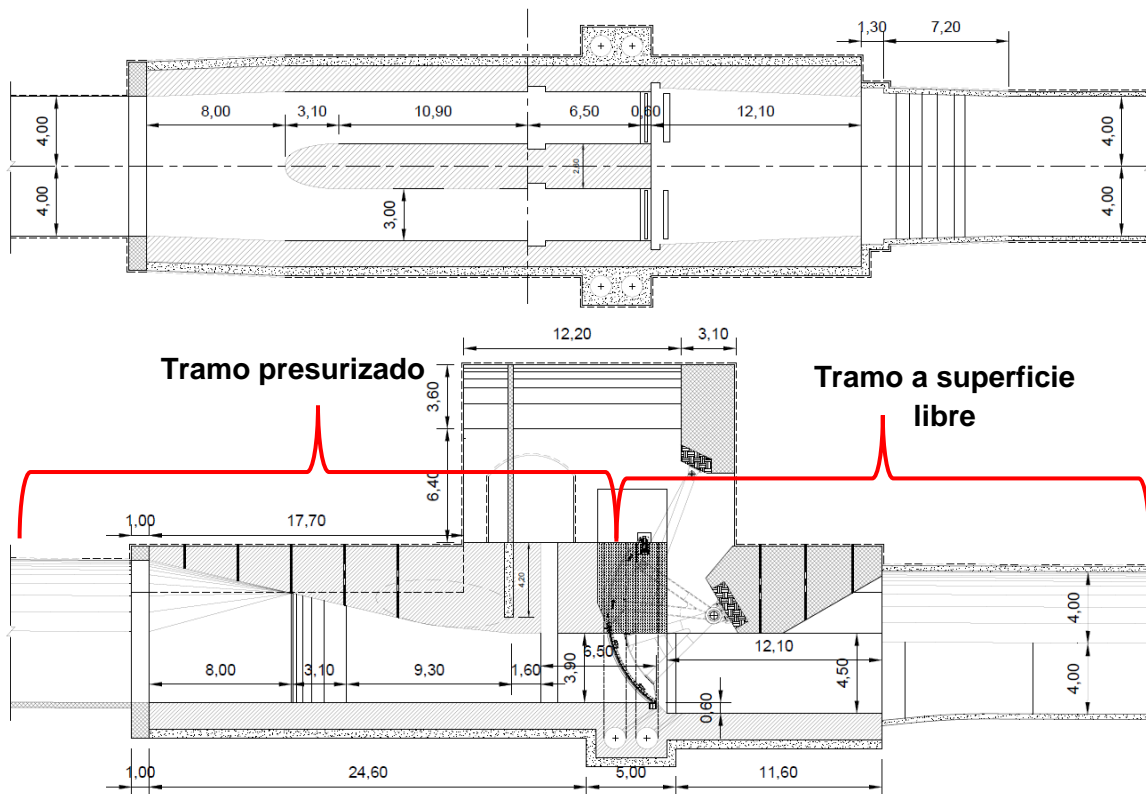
Configuración en planta y en perfil de la cámara de compuertas de la descarga de fondo.
